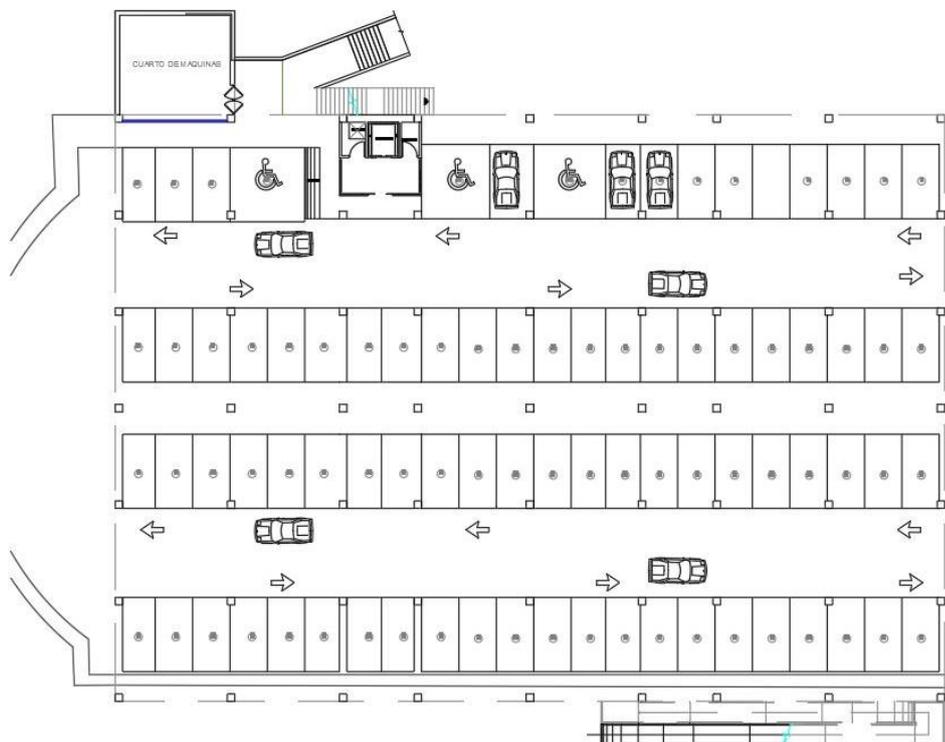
Planta estacionamientos arquitectónica N+0.00 m
